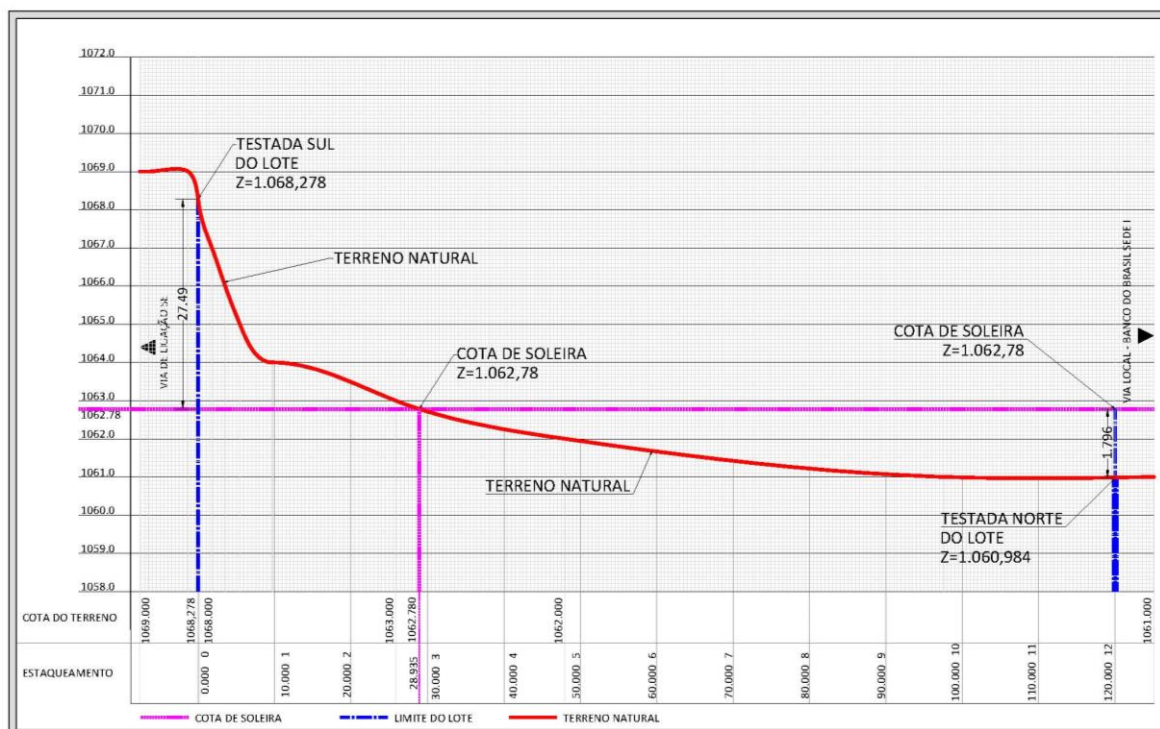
Corte longitudinal esquemático do relevo do lote A (elaborado com base no levantamento laser disponível no Geoportall SEDUH, acessado em 16 de janeiro de 2023).
